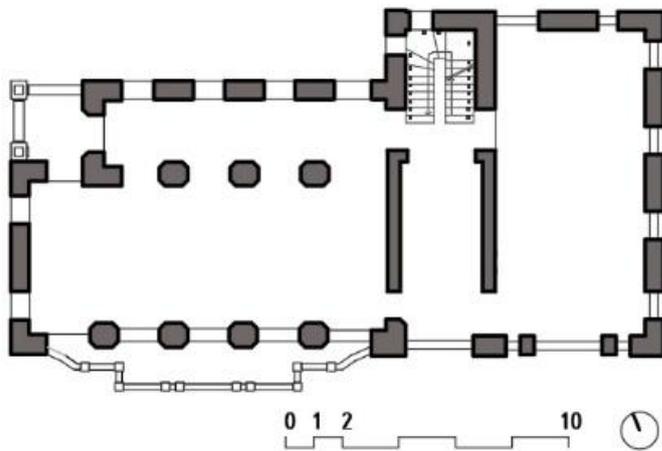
Sanatorio de Cesuras, planta primera. Elaboración propia
